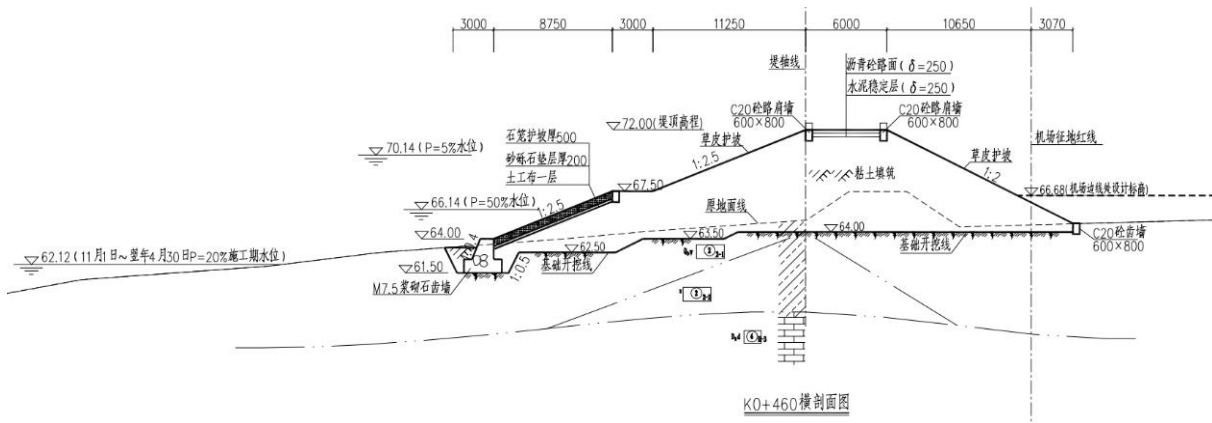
桩号 K0+460 土堤堤型剖面图
